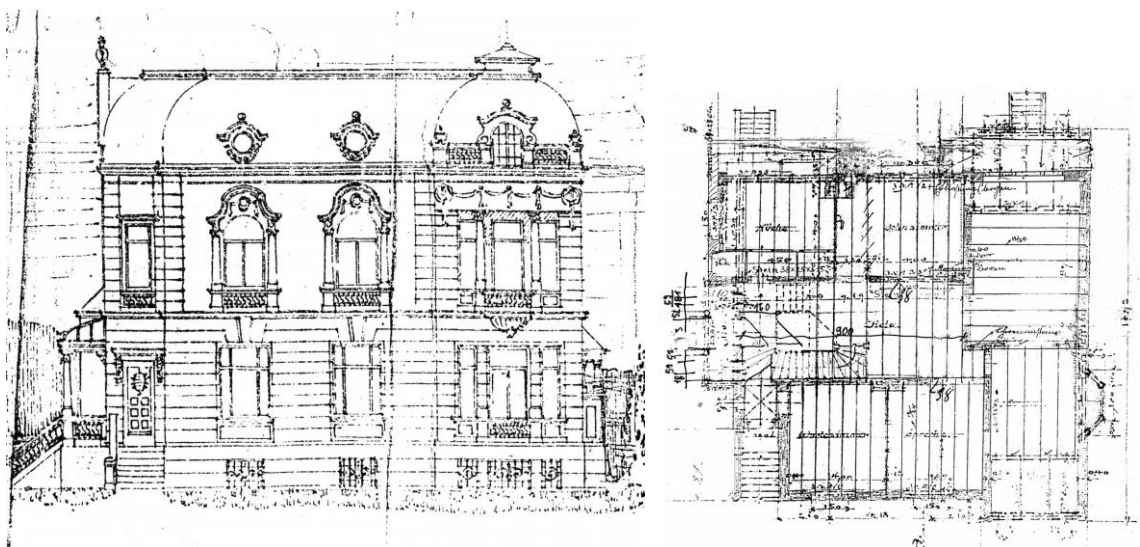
u. 3.2 – Straßenansicht (l.), Grundriss Erdgeschoss (r.)
